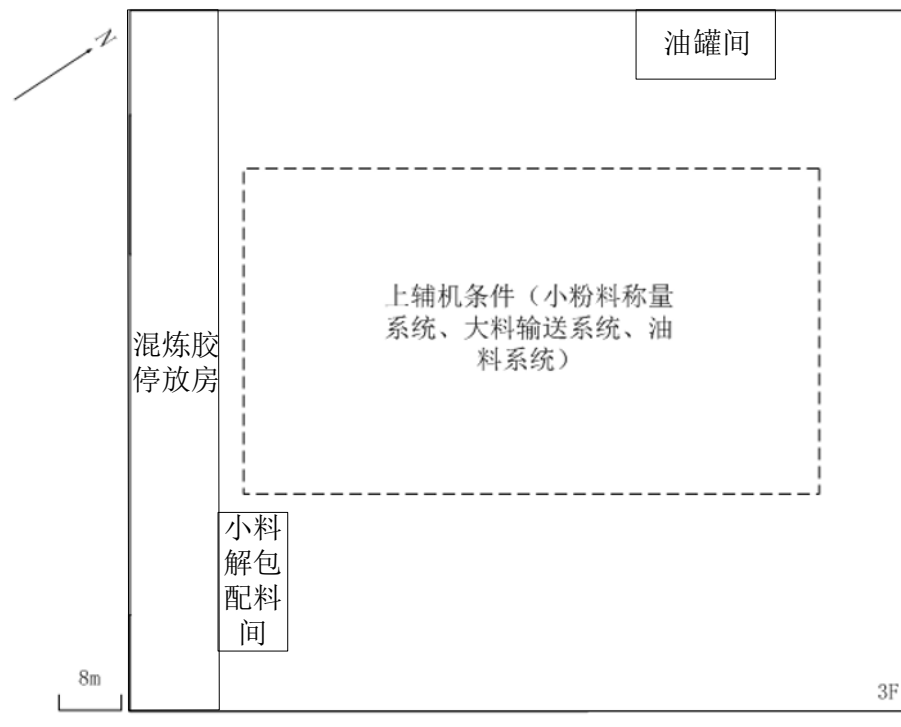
项目炼胶车间 3F 平面布置 (变动后)
